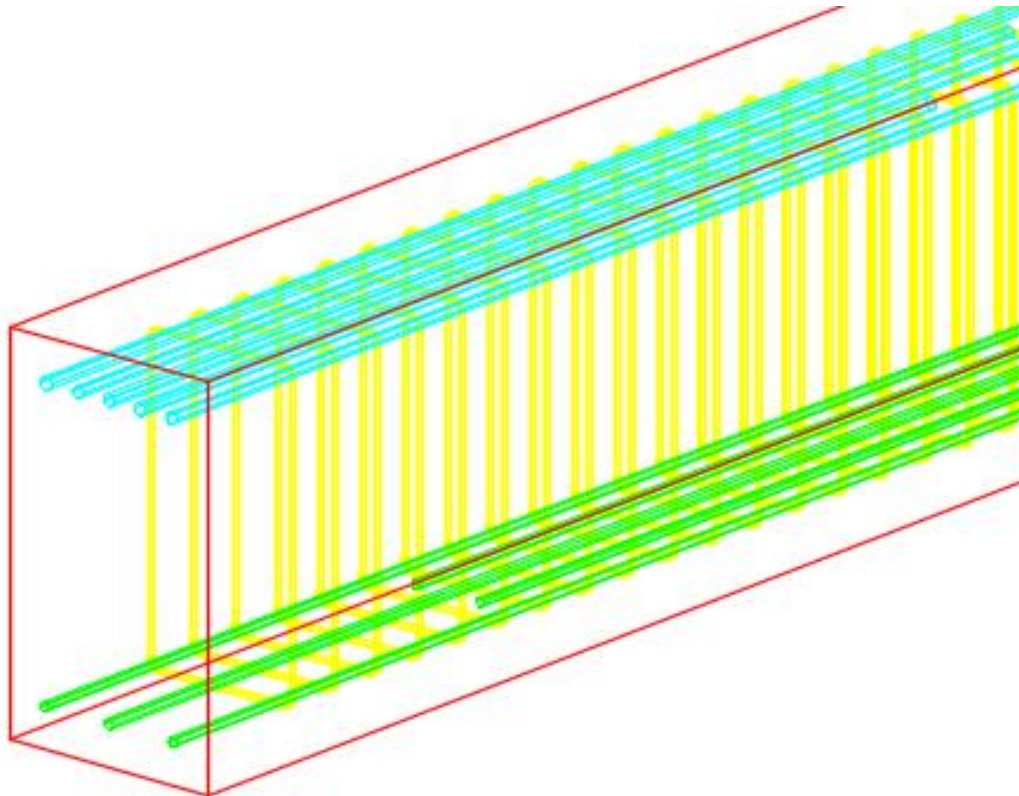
Pormenor da barra 6 com dispensas da armadura longitudinal.
